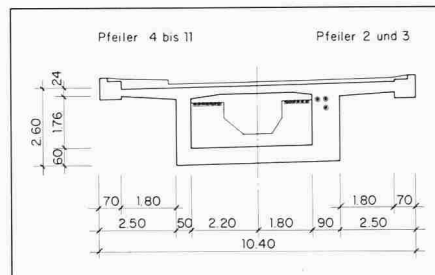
Querschnitt über den Stützen mit Kabelumlenksätteln
